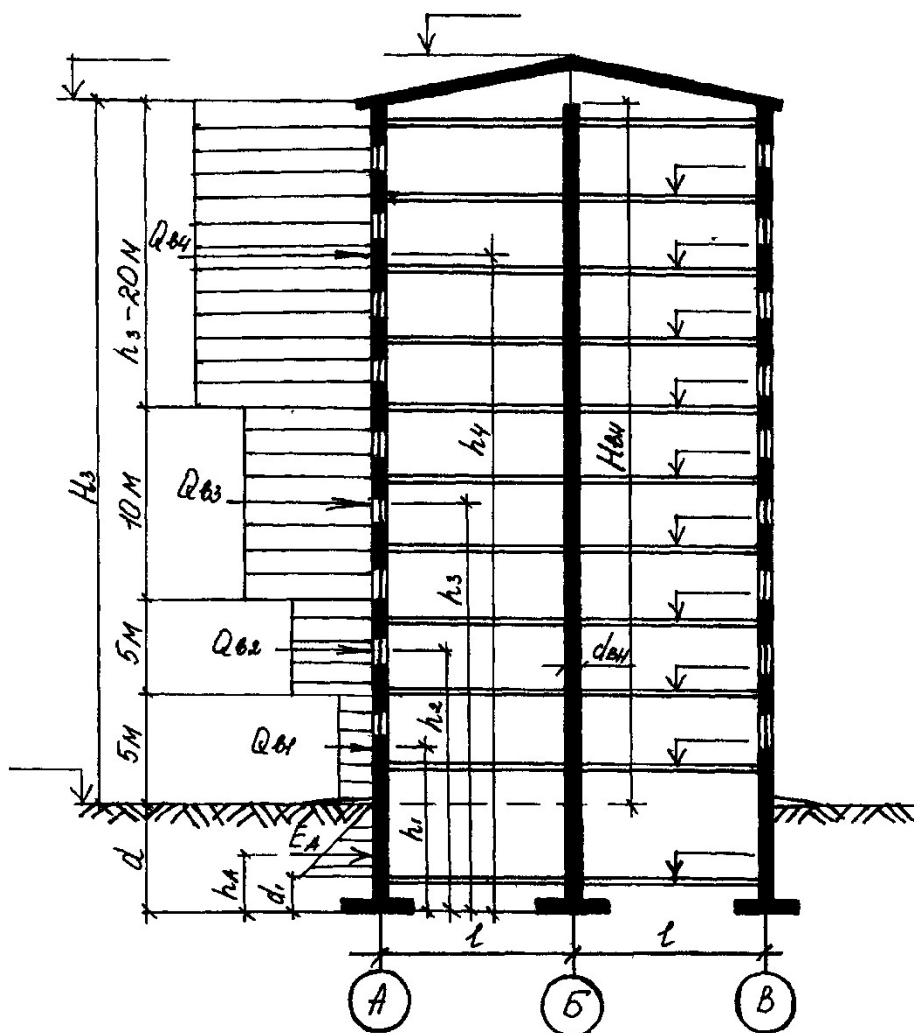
Схема дії горизонтальних навантажень на фундаменти
